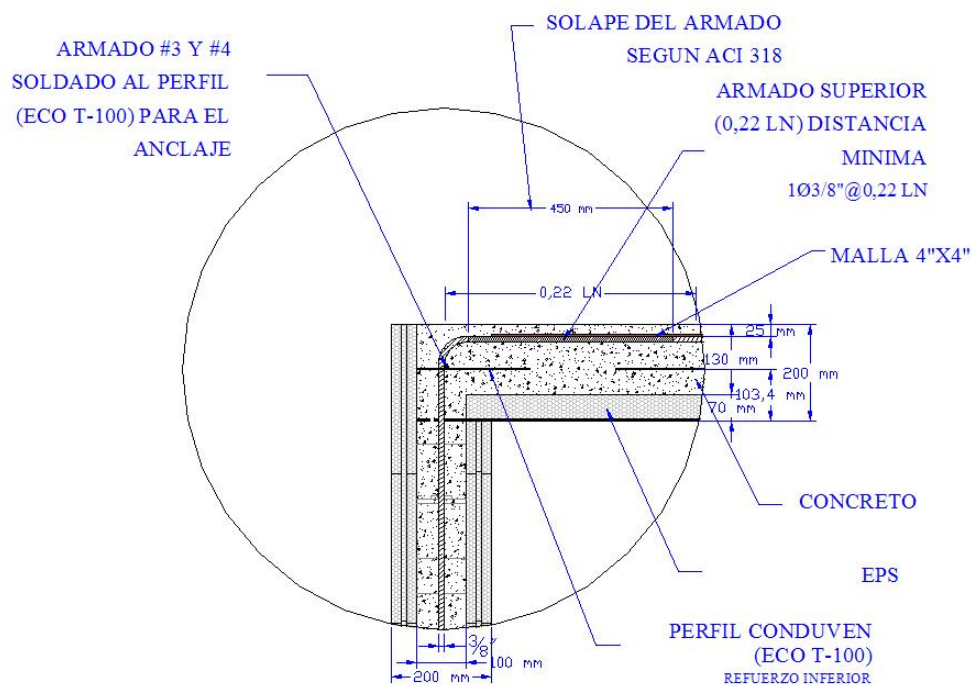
Detalle unión TERMOLOSA C con PROFORM.
